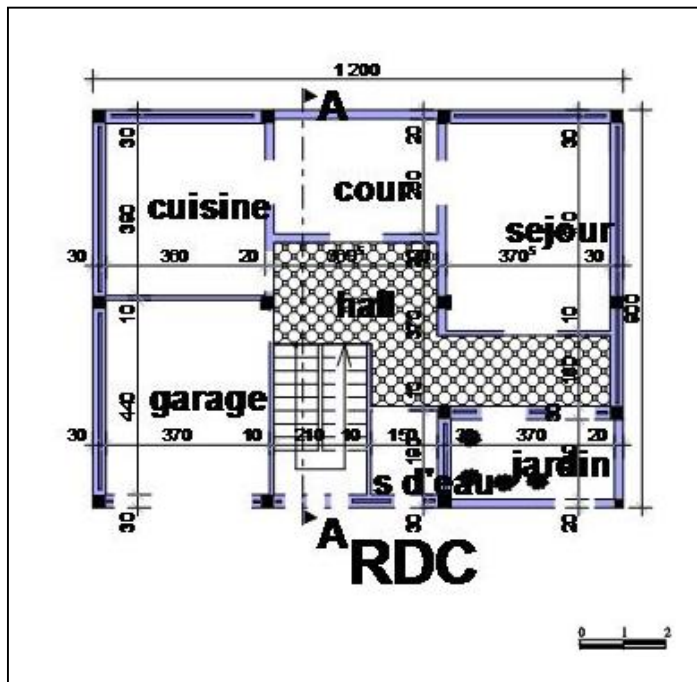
, échantillon 06, plan RDC d'une habitation individuelle, prise comme plan type d'une maison a niveau de revenus moyens, lotissement ENNAHDA
